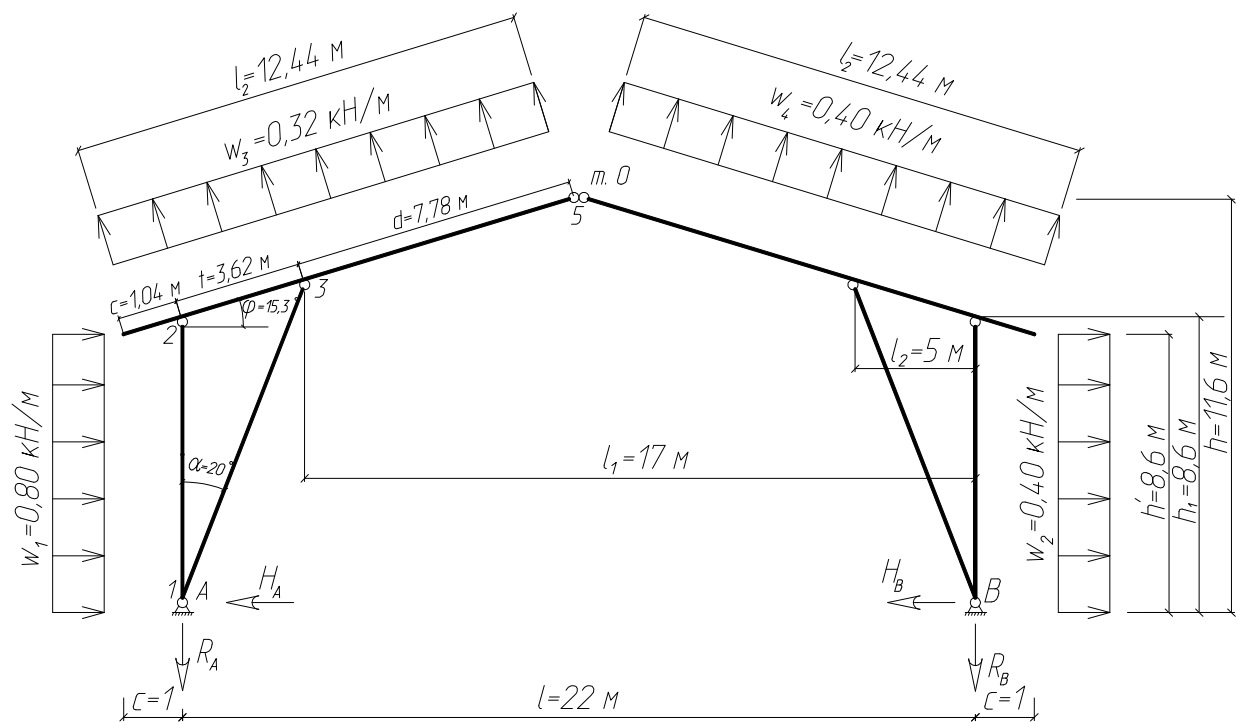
Расчетная схема рамы на ветровую нагрузку
